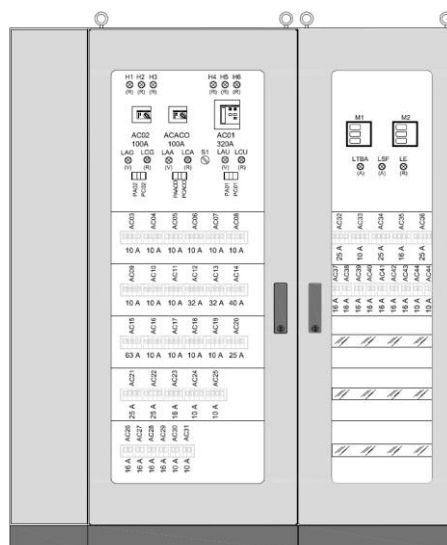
Vista frontal de un Panel Corriente Alterna (PCA)
